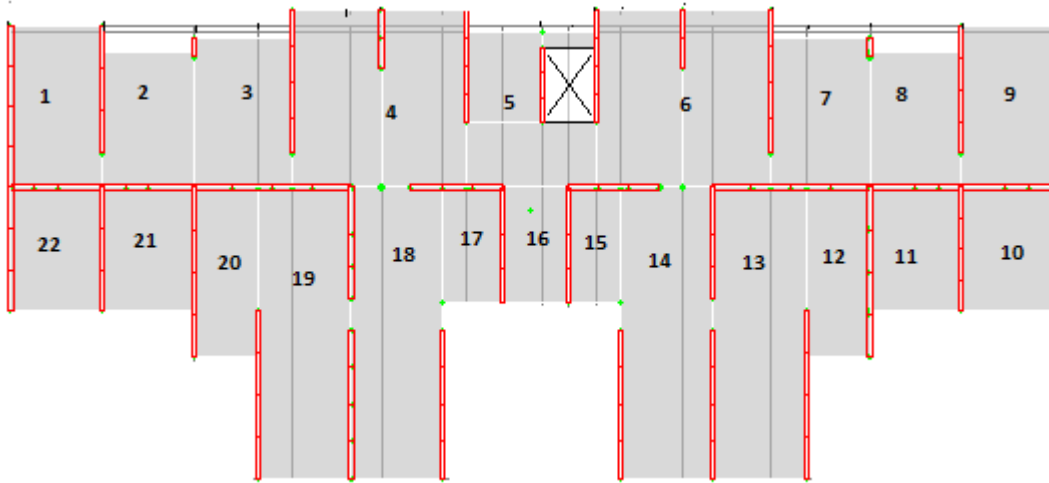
Schéma de la distribution des panneaux de la dalle.
